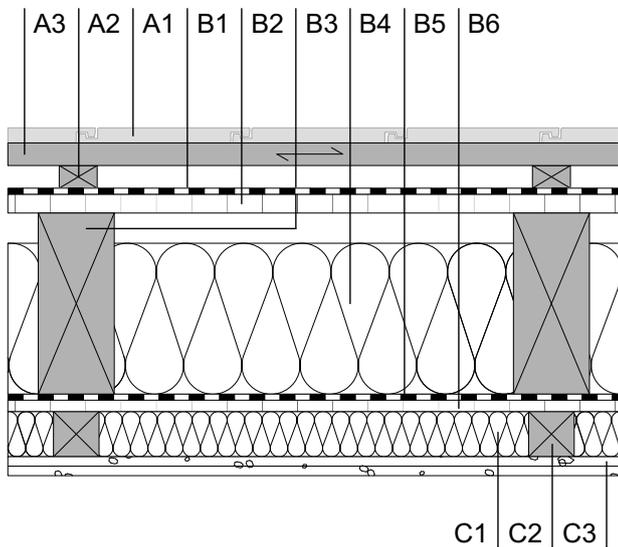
Vertikalschnitt Steildachaufbau DA2, M 1:10
